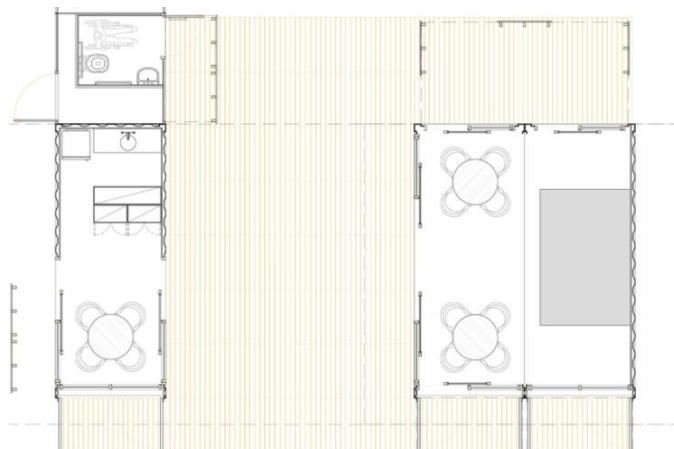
Planta arquitectónica - Tienda Alphaville
